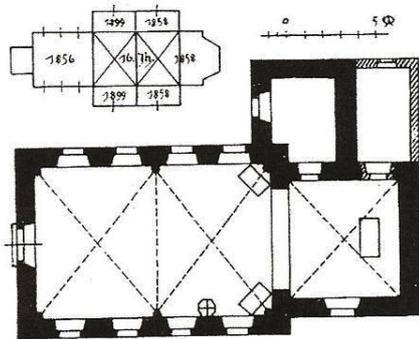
Freudenburg. Grundriß der alten Pfarrkirche, mit Erweiterungsschema.
